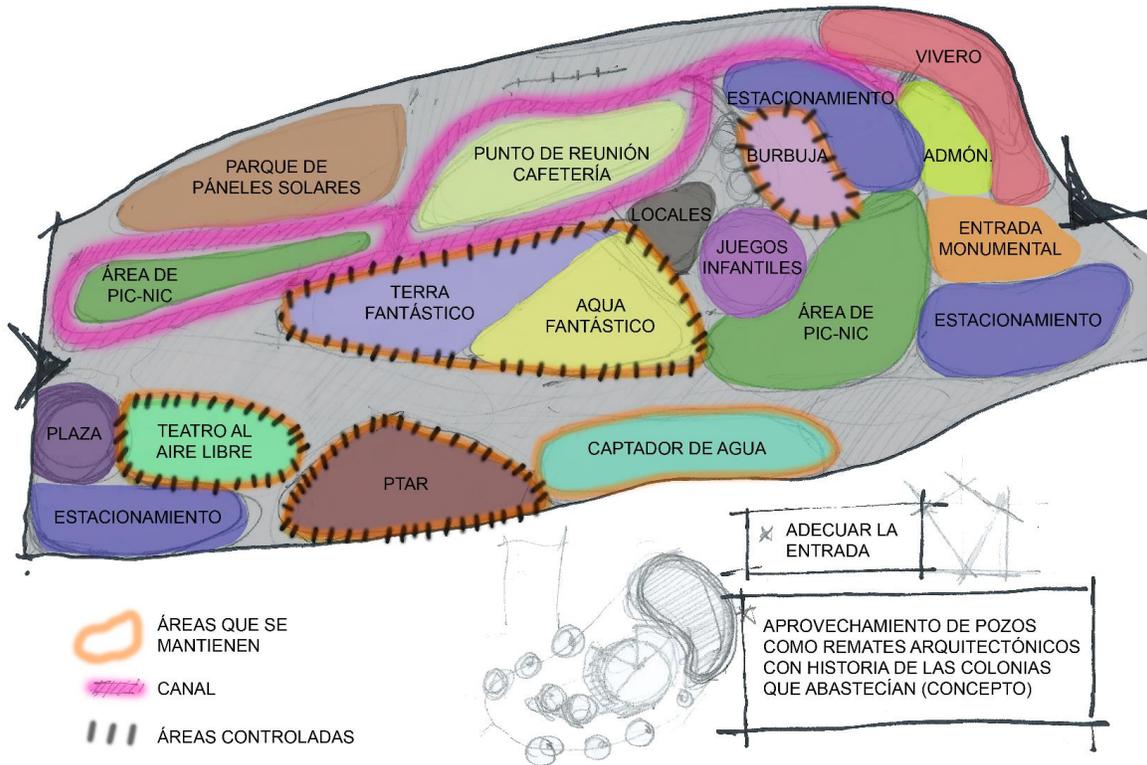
Propuesta de zonificación del Plan Maestro. Fuente: Propia. S/E
